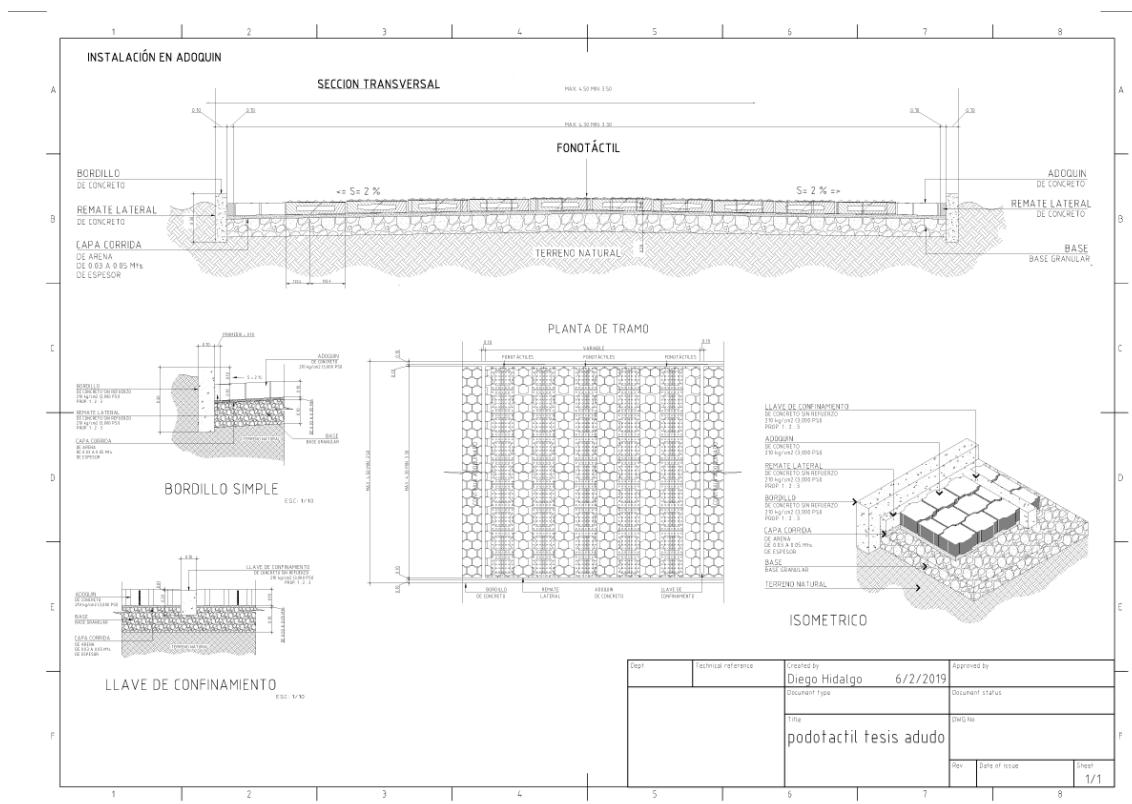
Plano de detalle de instalación de fonotáctiles para arena (adoquinado).
